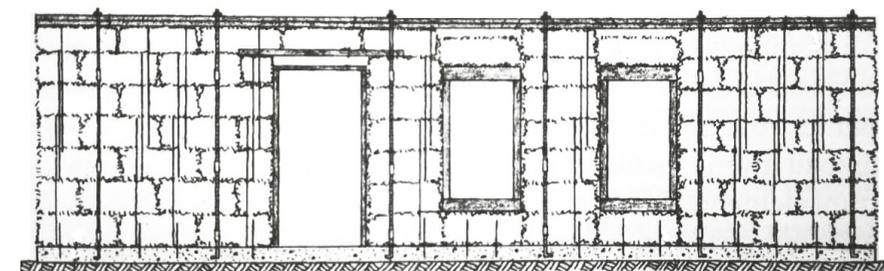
Sezione di un muro pre-compresso con barre filettate.
